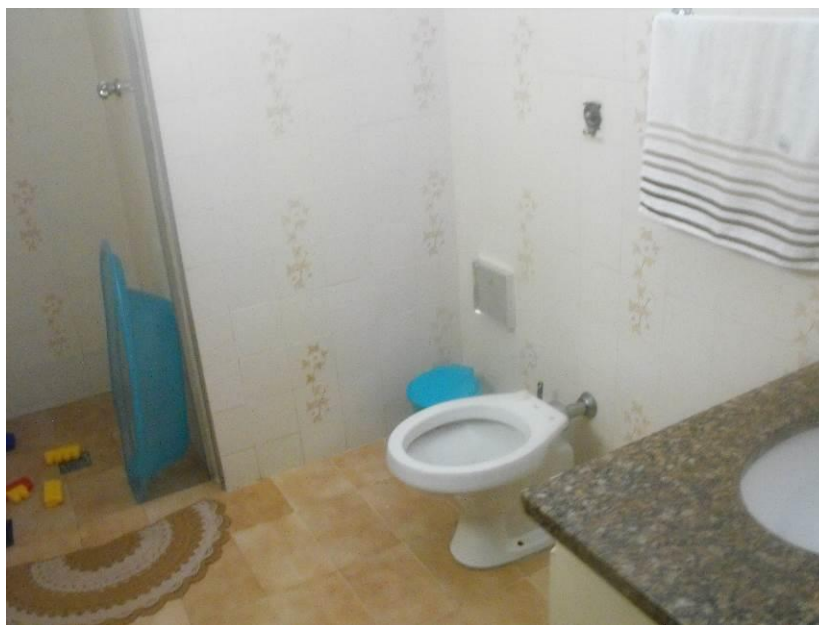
Mostrando um dos banheiros do pavimento superior do prédio.
